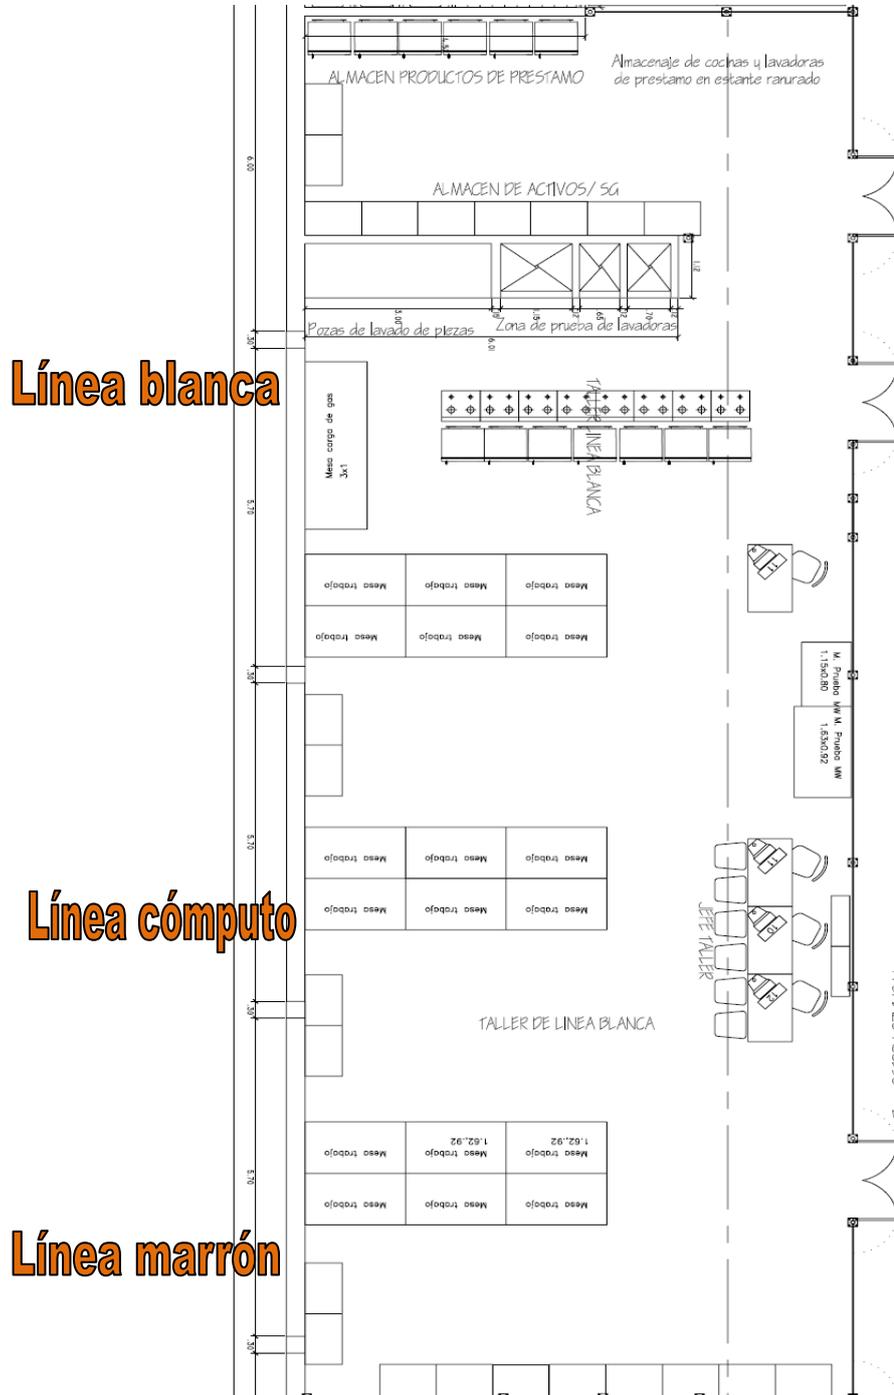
Vista de planta de taller de servicio técnico
